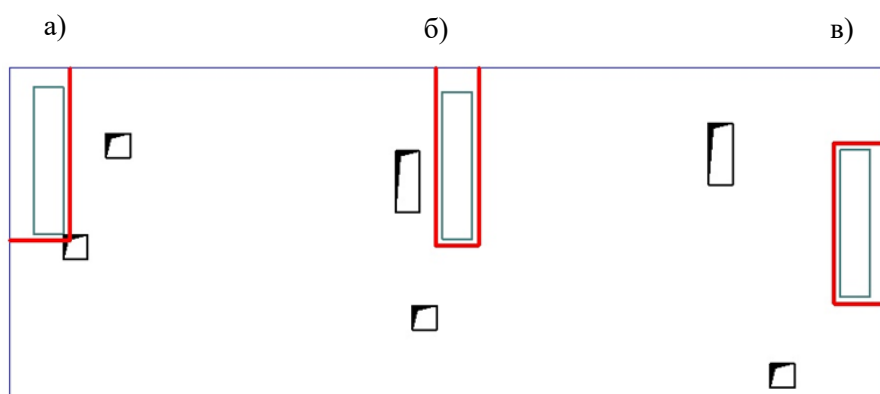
Различные варианты отрисовки базовых незамкнутых контуров продавливания: а) пилон располагается у угла плиты перекрытия; б) пилон располагается вблизи края плиты перекрытия короткой стороной; в) пилон располагается вблизи края плиты перекрытия длинной стороной (красным показаны контуры продавливания)
